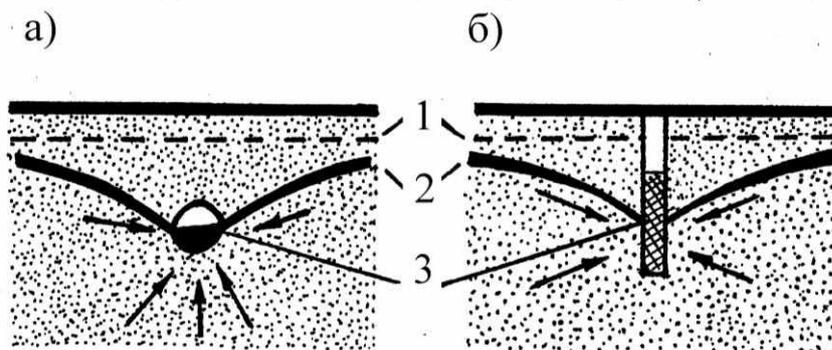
Схема работы дренажа: а) горизонтального; б) -вертикального
